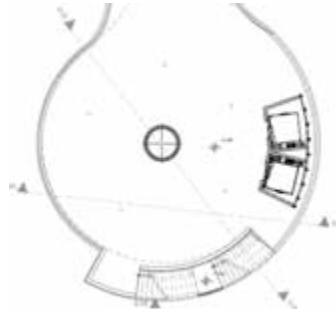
Plaza de acceso 3, planta 1. (+5.45m). (2017)
